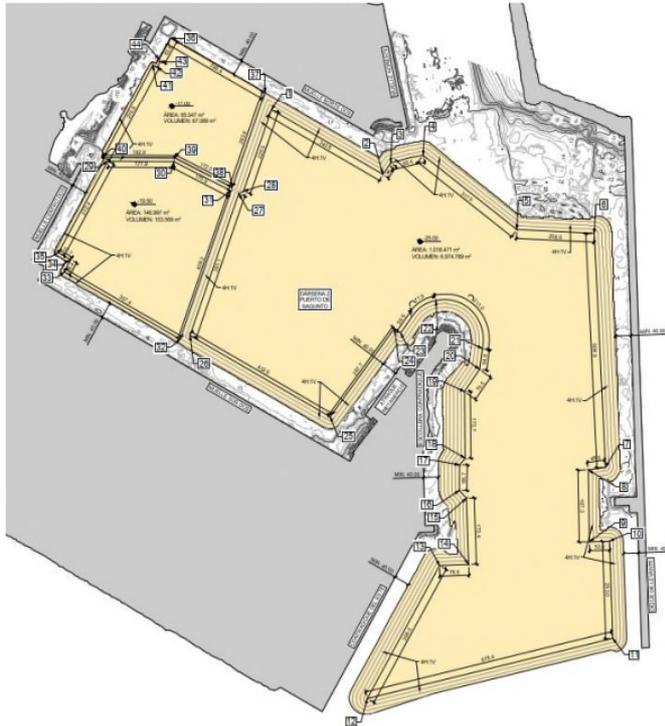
Planta del dragado en el Puerto de Sagunto. Fuente: Proyecto.
